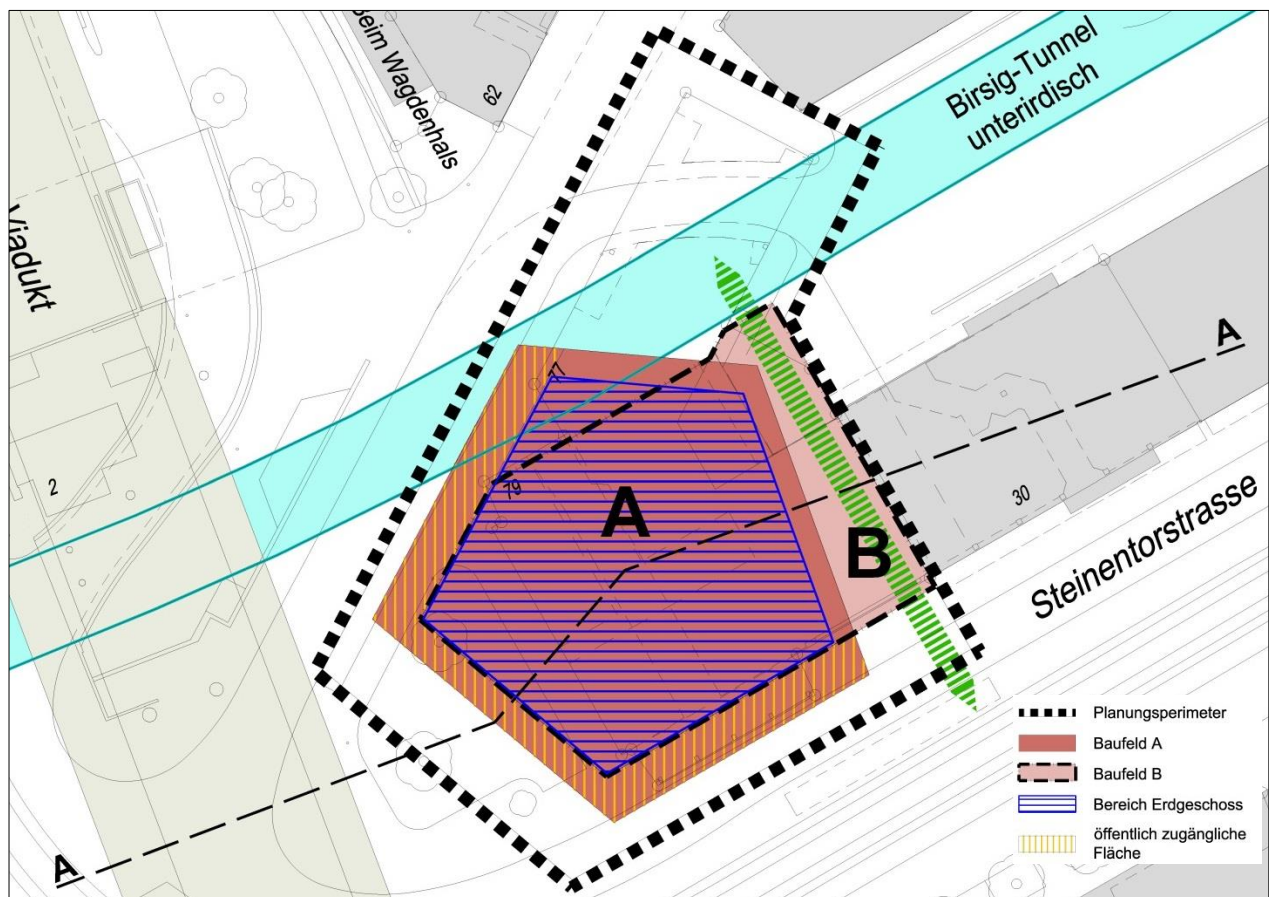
Bebauungsplan. Situation (Kein Massstab, Plan genordet)
